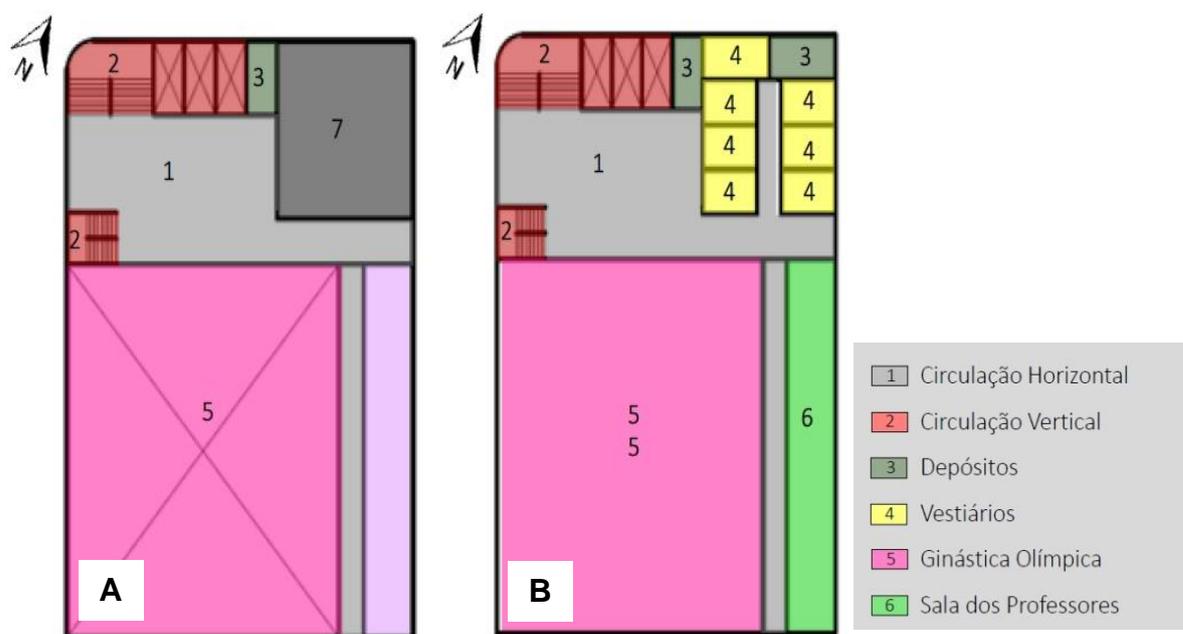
A)Planta baixa 6º pavimento. B) Planta baixa 7º Pavimento.
